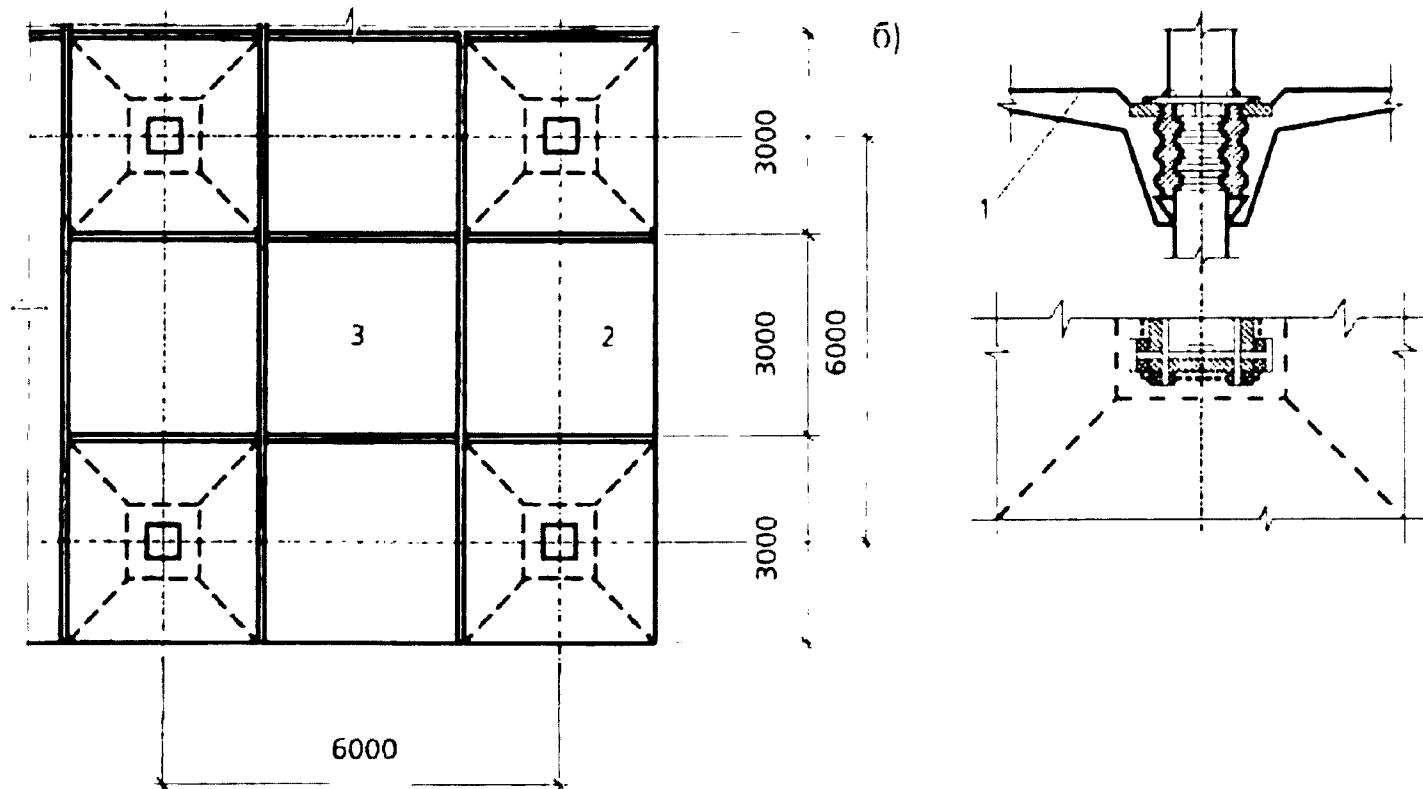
Сборное безбалочное перекрытие: 1 - канигель; 2 - надколошная плита; 3 - пролетная плита
